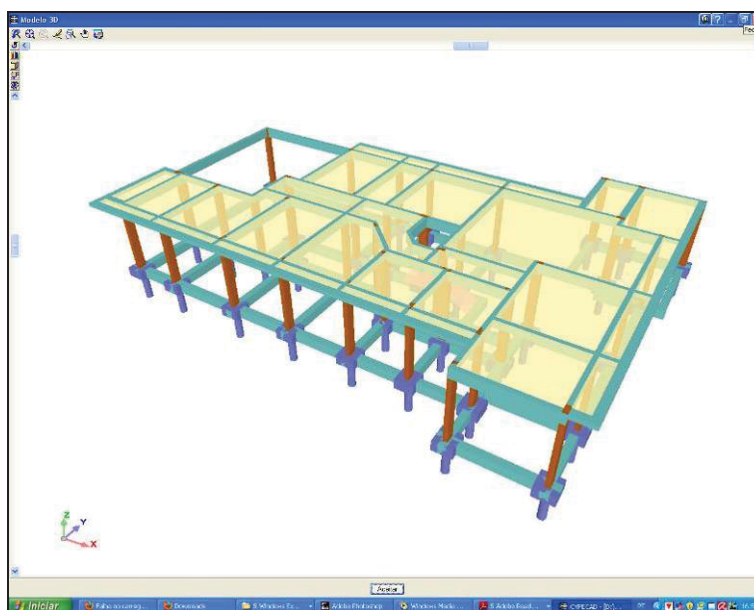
CYPECAD ILUSTRANDO UMA EDIFICAÇÃO MODELADA EM 3D
